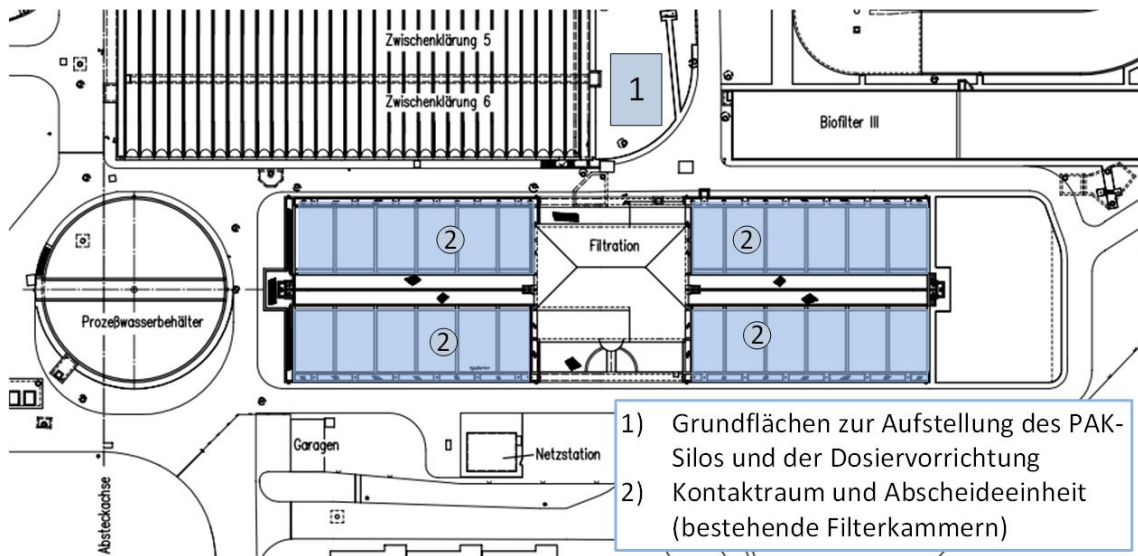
Lageplan der Variante 2 auf dem Klärwerk Krefeld
